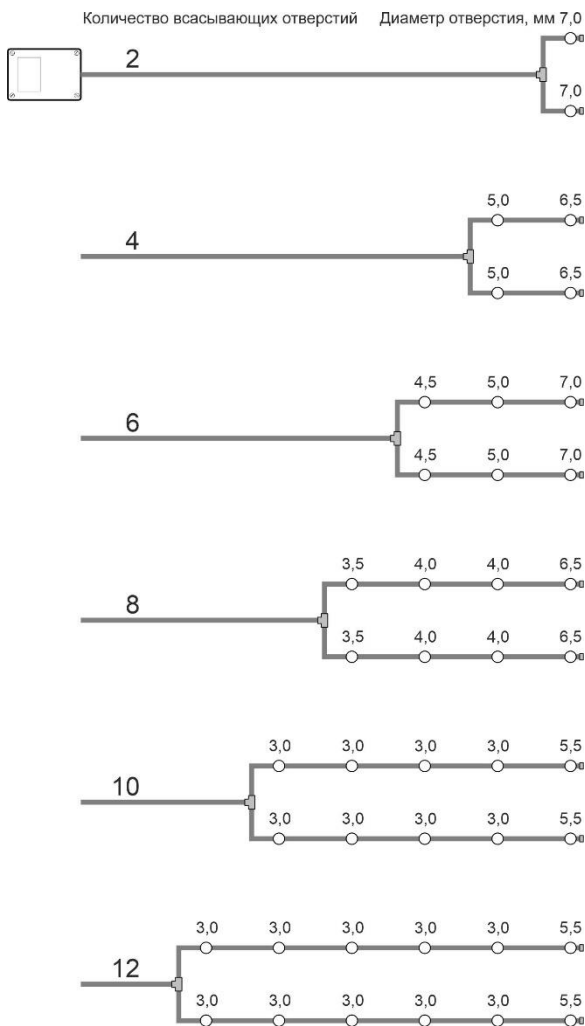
Размер всасывающих отверстий (U- или T-образная топология)
